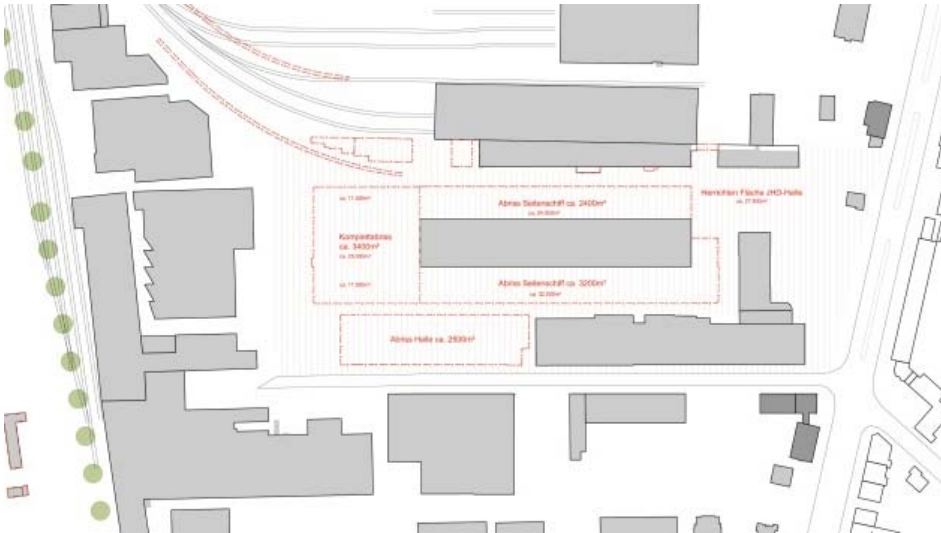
Abriss Bauteile Jahrhunderthalle
